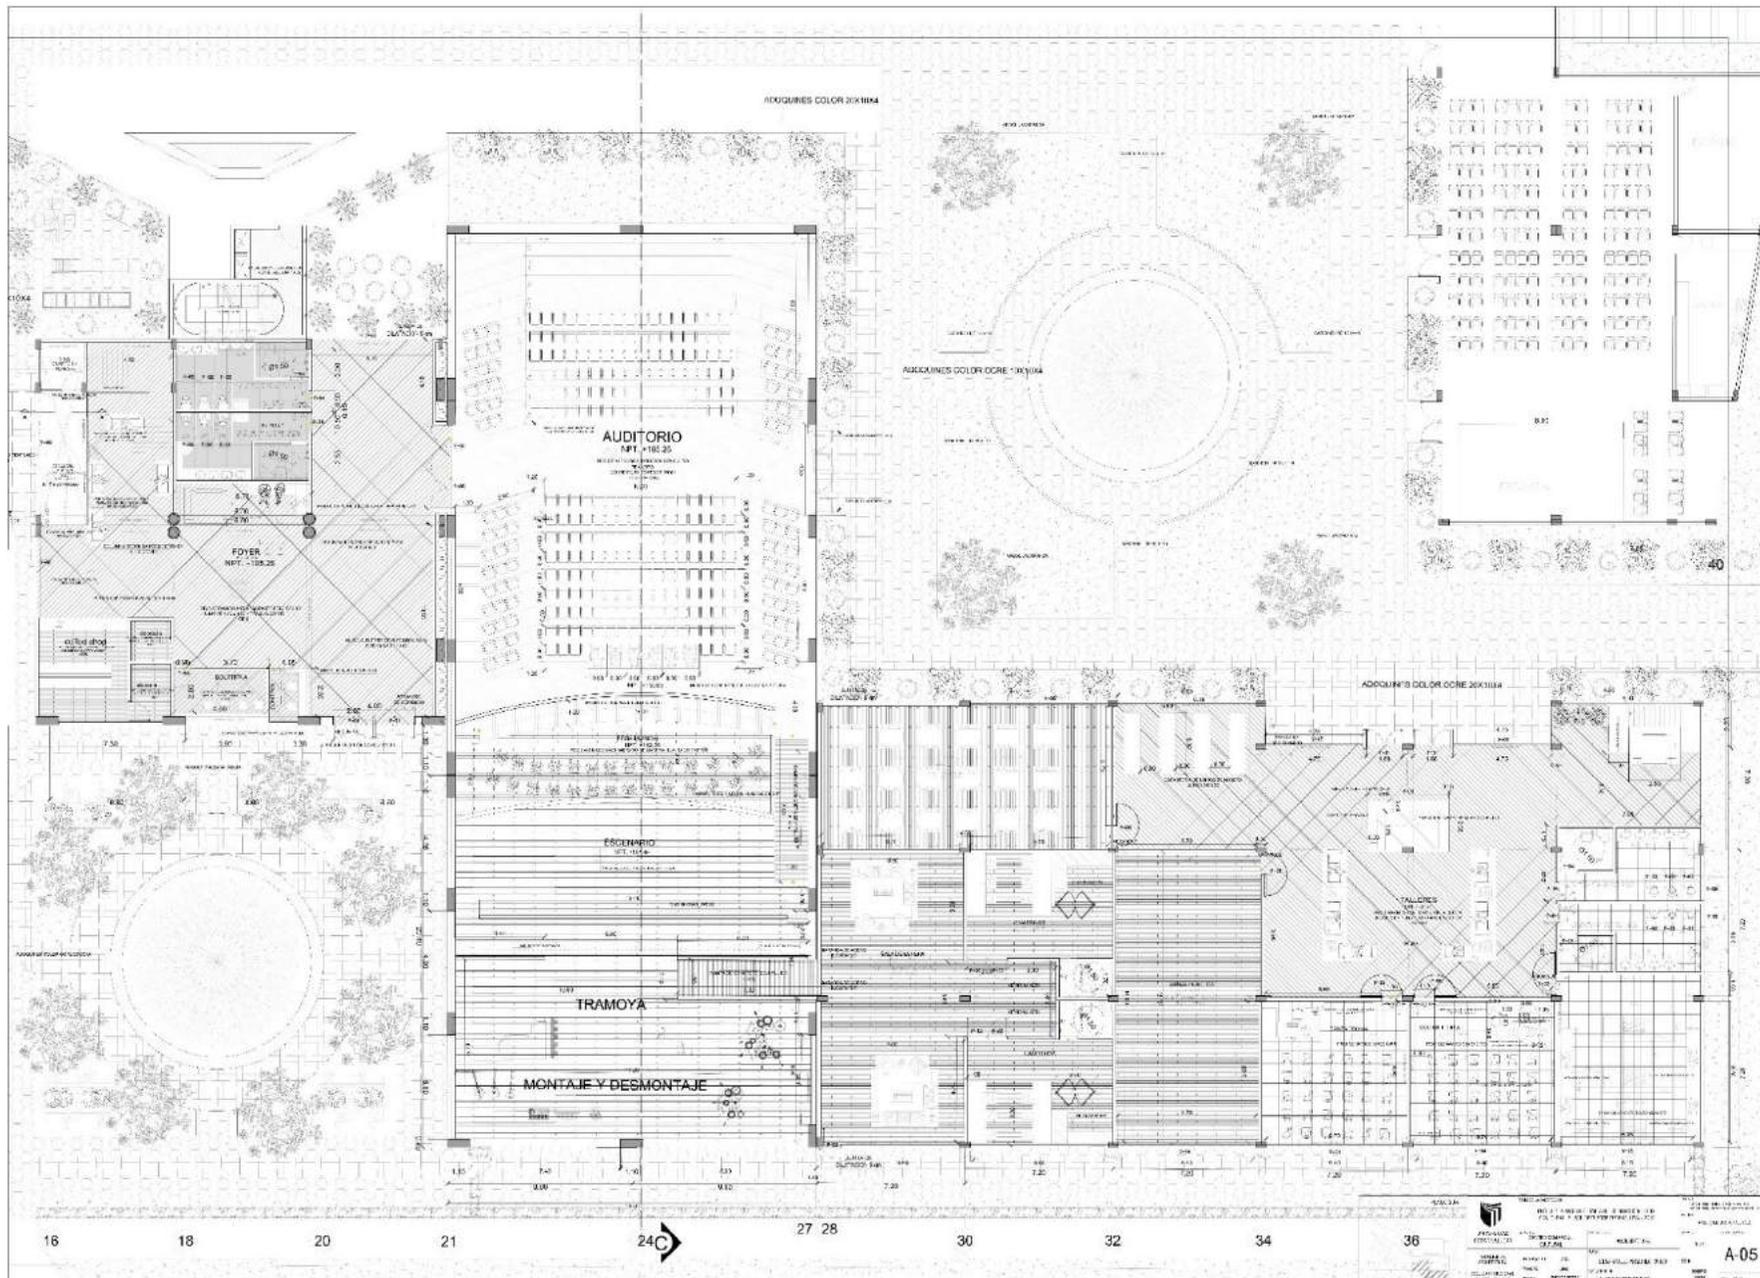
Plano de primer nivel – zona cultural. Elaboración propia.
